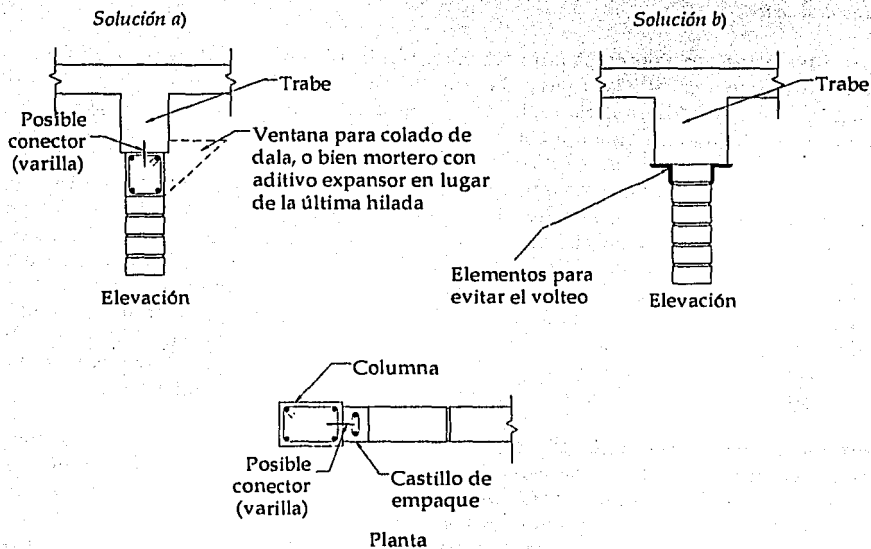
Muro diafragma enmarcado en secciones de concreto
